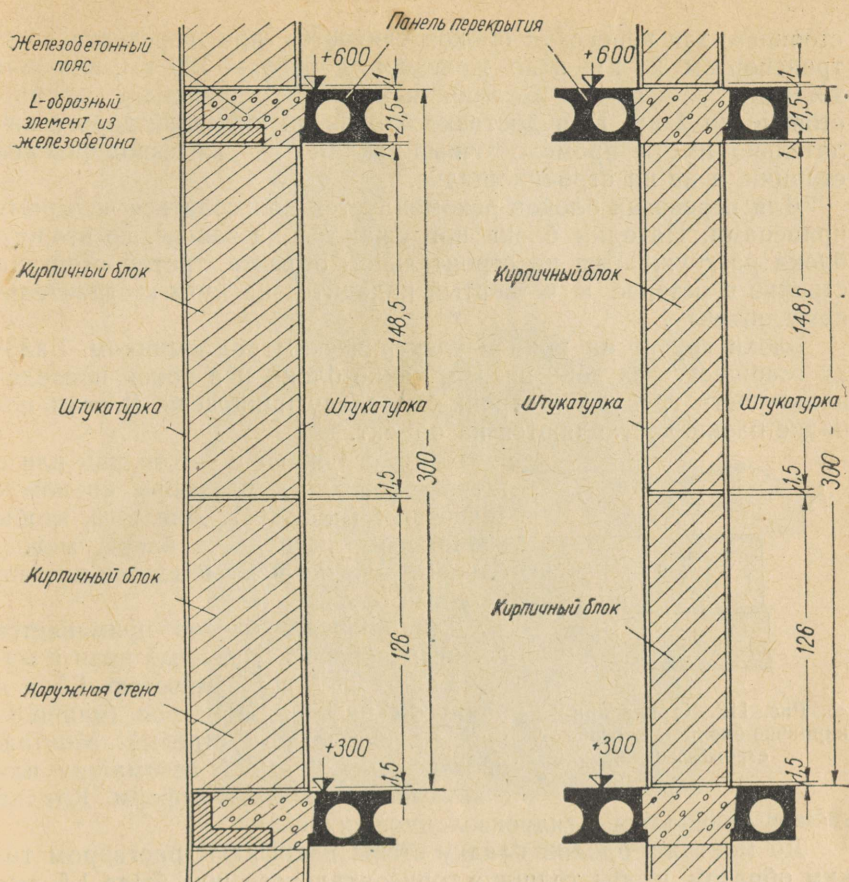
Соединение панели перекрытия с поперечными стенами.
